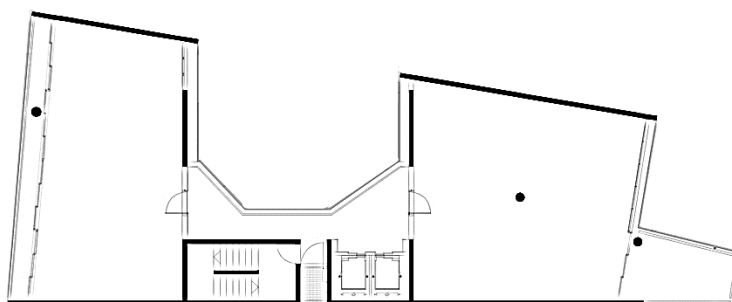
Ed. Simpatia 236, pavimento tipo composto por duas plantas flexíveis.
